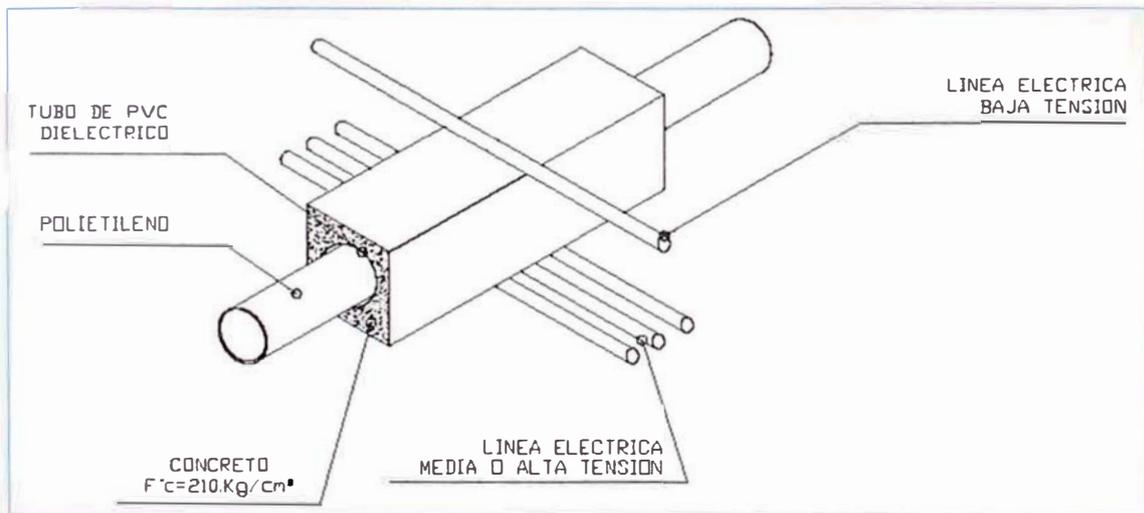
Esquema de protección mecánica de la tubería de polietileno.
